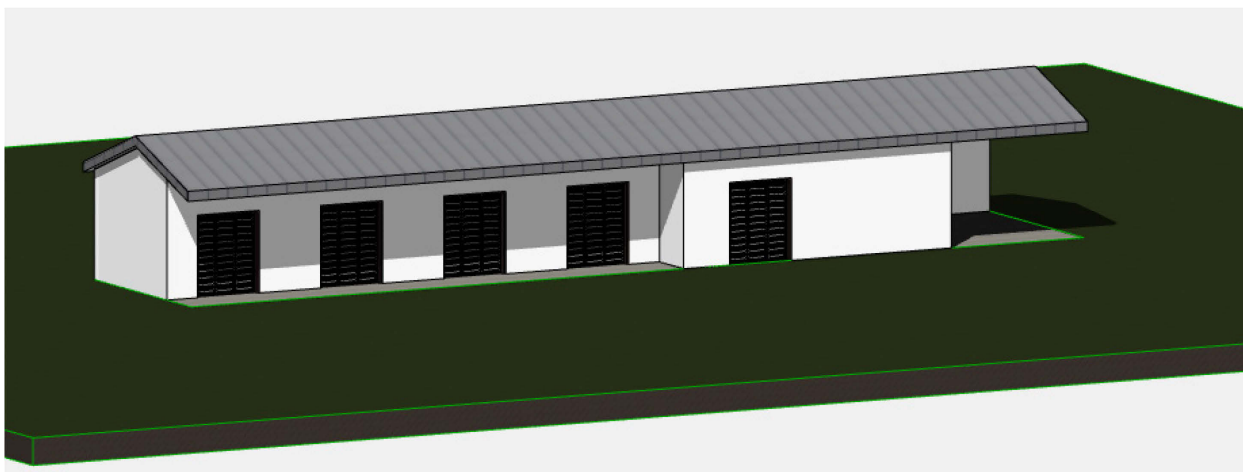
Dienstbürogebäude Dachvariante Satteldach-Pultdach
